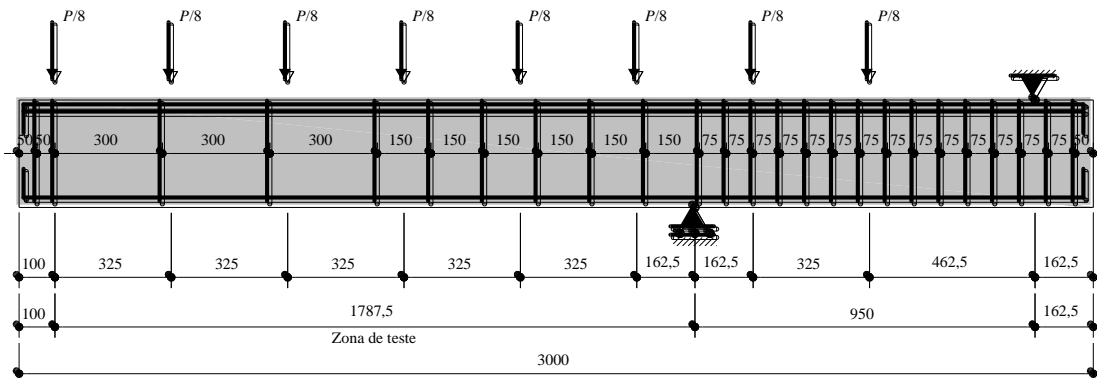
Arranjo dos reforços da viga B15H30CF00 (cotas em mm).
